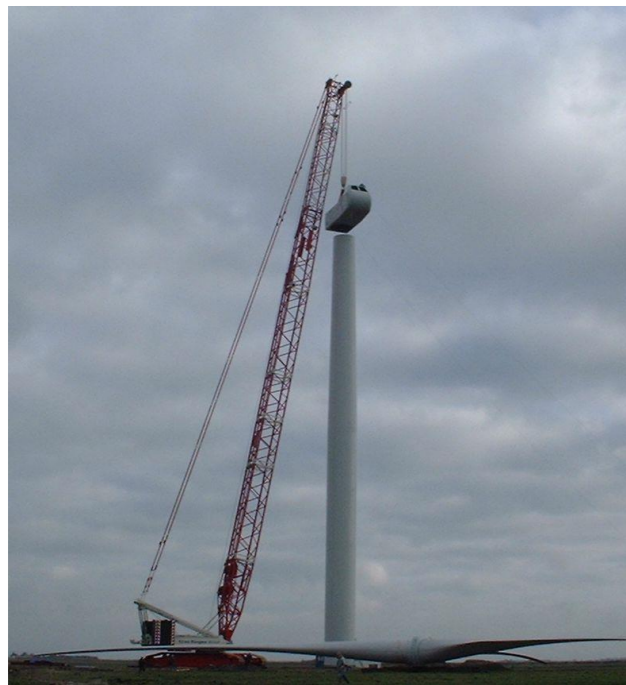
Installation de la nacelle (Photo : VALOREM)
